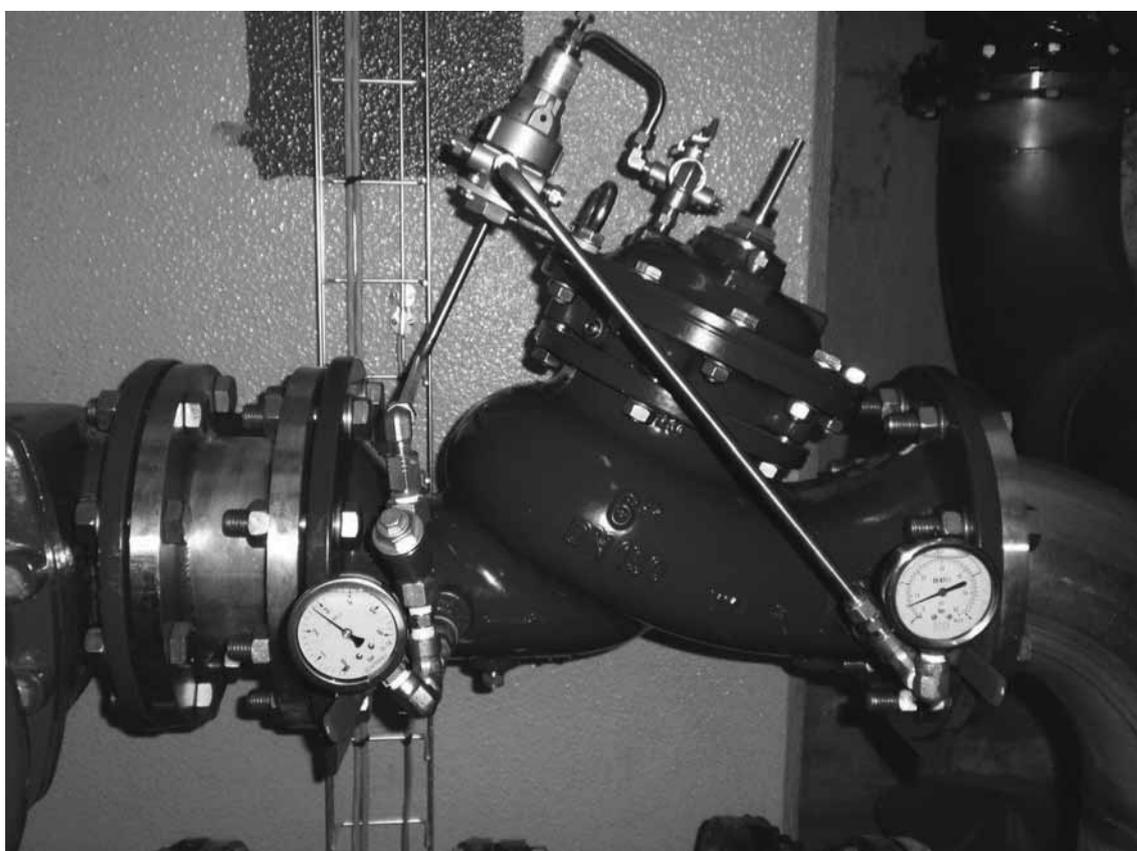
Peças Especiais da Vican – Estação Elevatória de Brinches Enxóé
